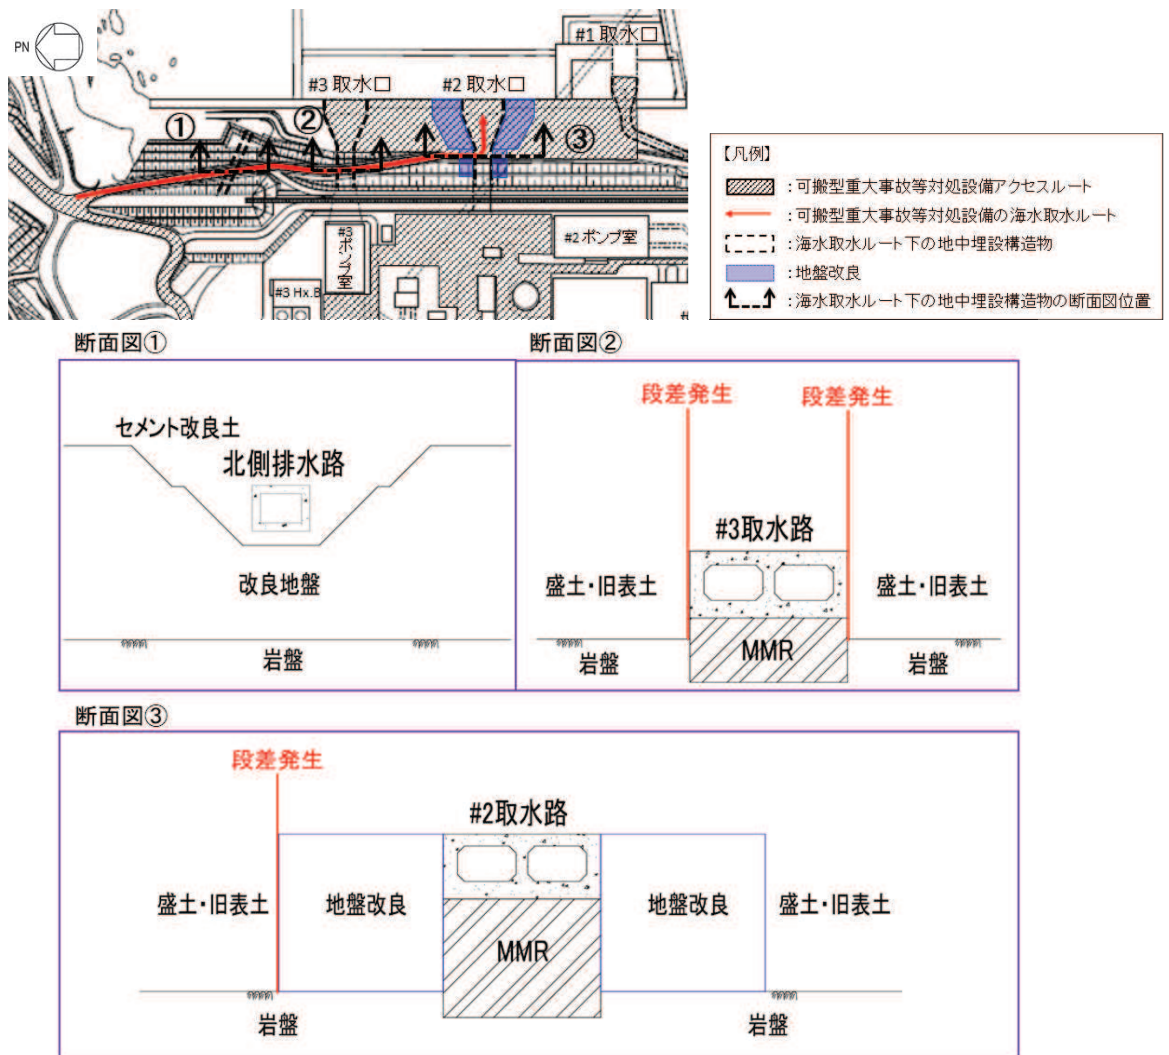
海水取水ルート下の地中埋設構造物の位置及び断面図
